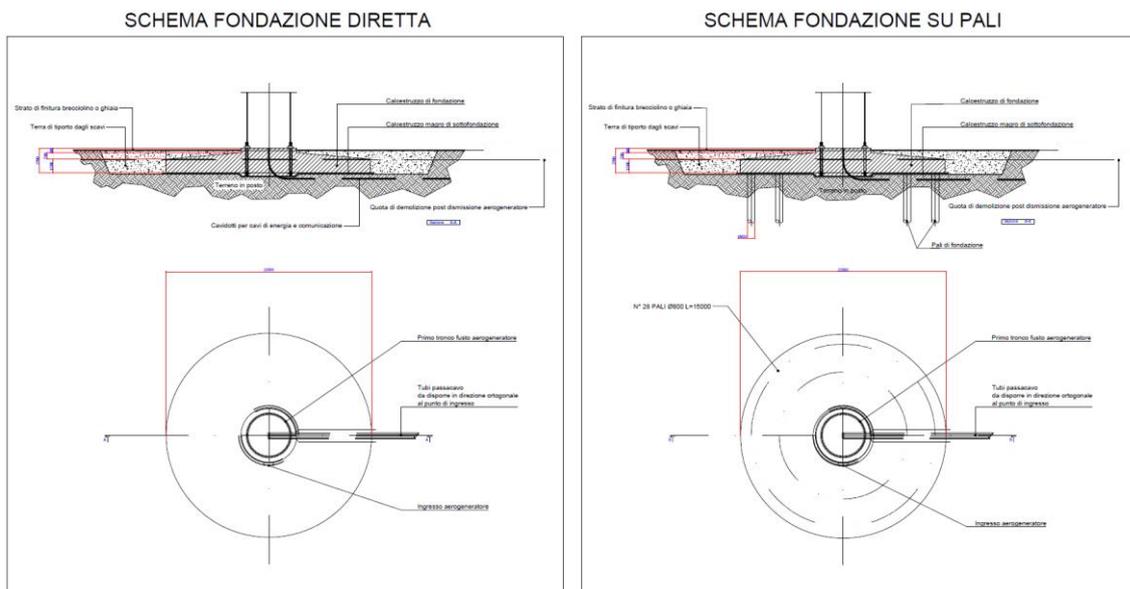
Tipico plinto di fondazione degli aerogeneratori
